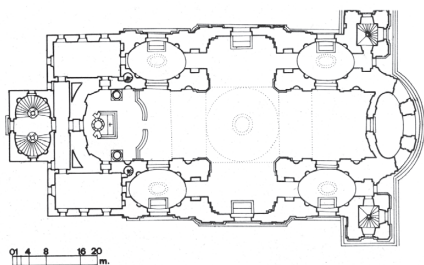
Planta baixa da Kollegienkirche, a igreja da Universidade, em Salzburg. Projetada por Fischer von Erlach e construída entre 1696 e 1707.
